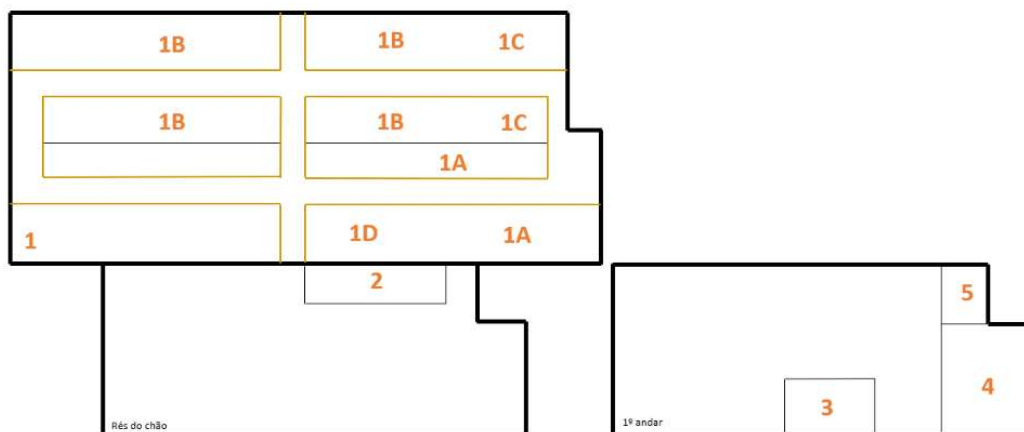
Planta Instalações SF Moldes (Fonte Própria)
